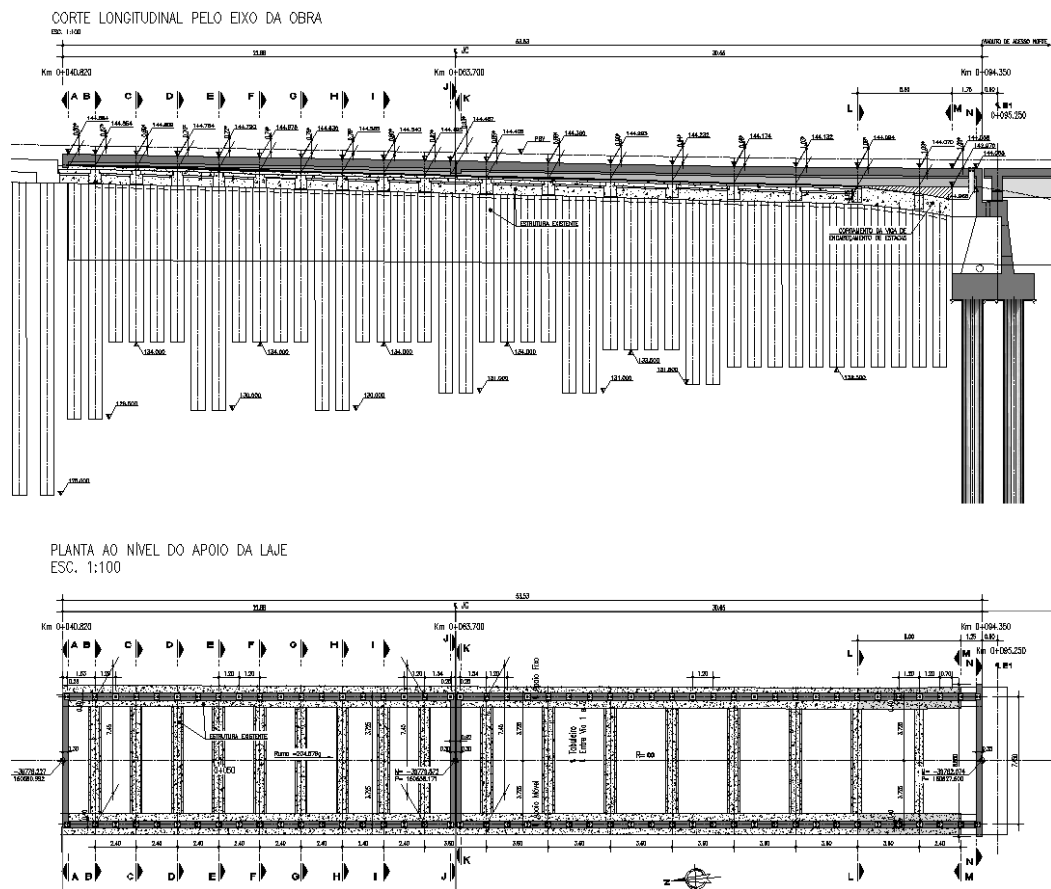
Corte e planta da Via de Resguardo em Trincheira
